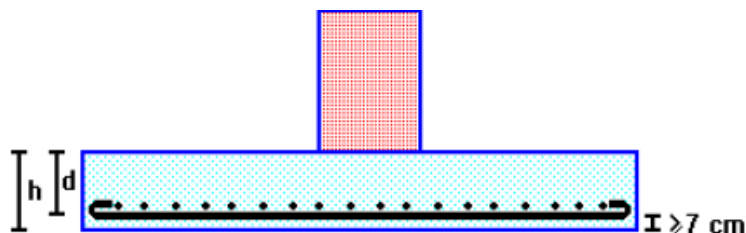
Recubrimiento mínimo en cimentaciones.
